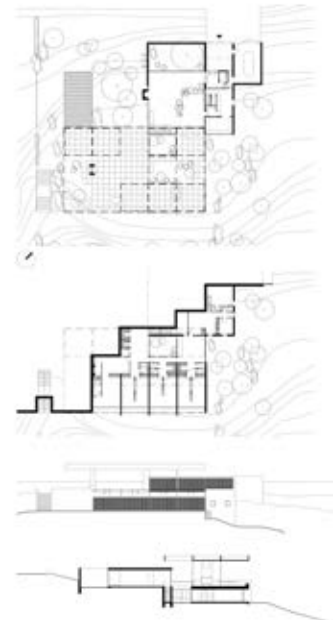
Casa Castanera (Gerona, 1964) Planos de plantas, alzado este y sección transversal. (Redibujado por el autor sobre la base de la documentación original).
